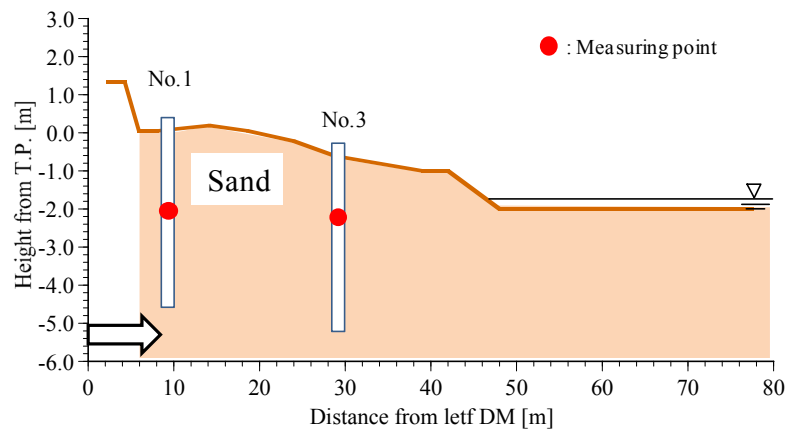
St.2-1 の横断面図と測定位置（機器は井戸内に設置されている）
